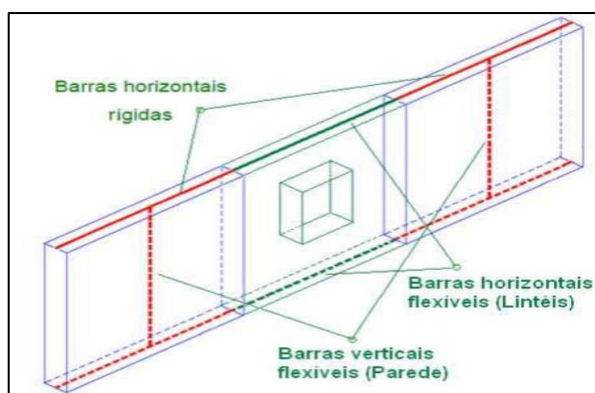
Discretização de uma parede com o Modelo Pórtico Tridimensional.
